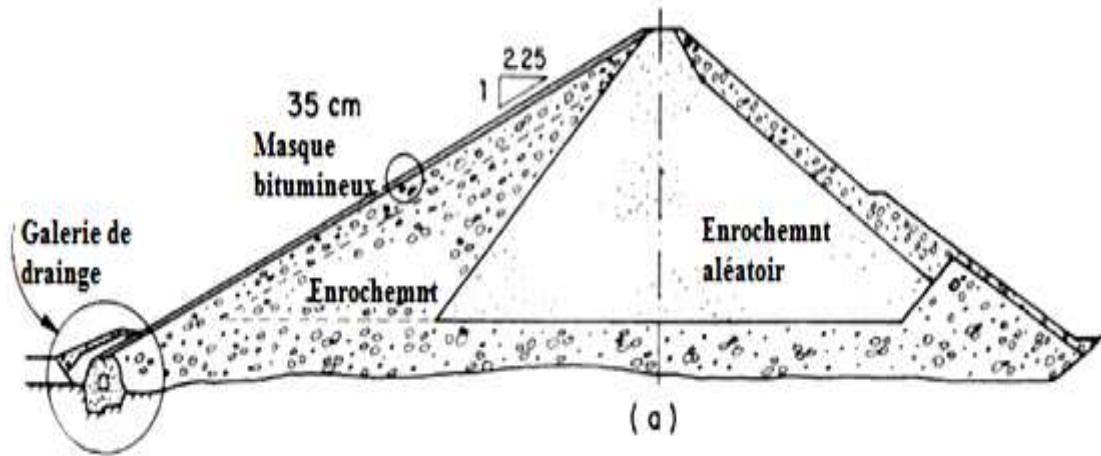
Barrage de Genkel. Section typique avec détails du masque (Sherard et al., 1963).
